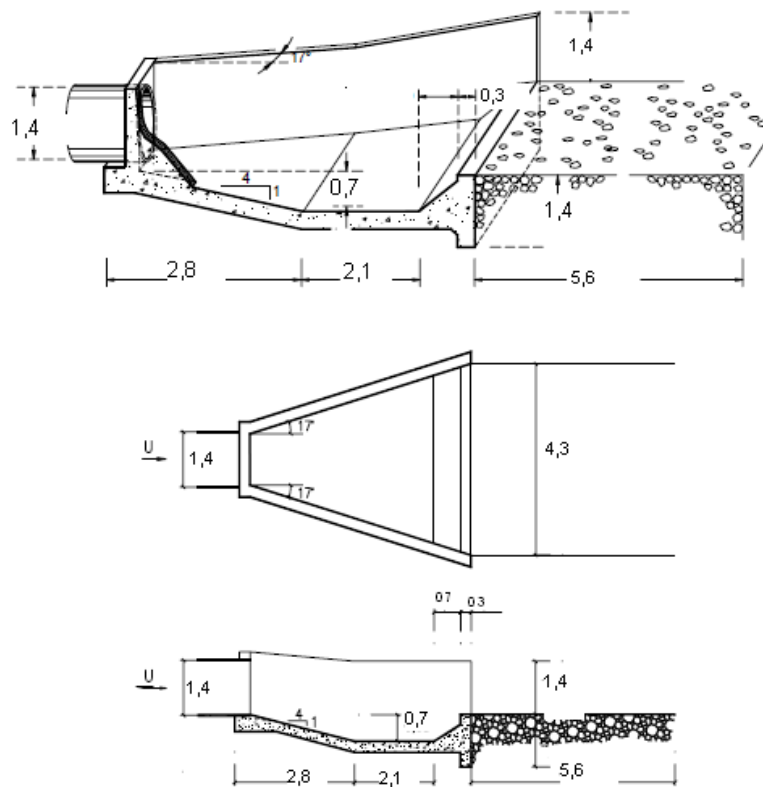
Esquema de bacia de dissipação por ressalto. Vista 3D, planta e perfil.
